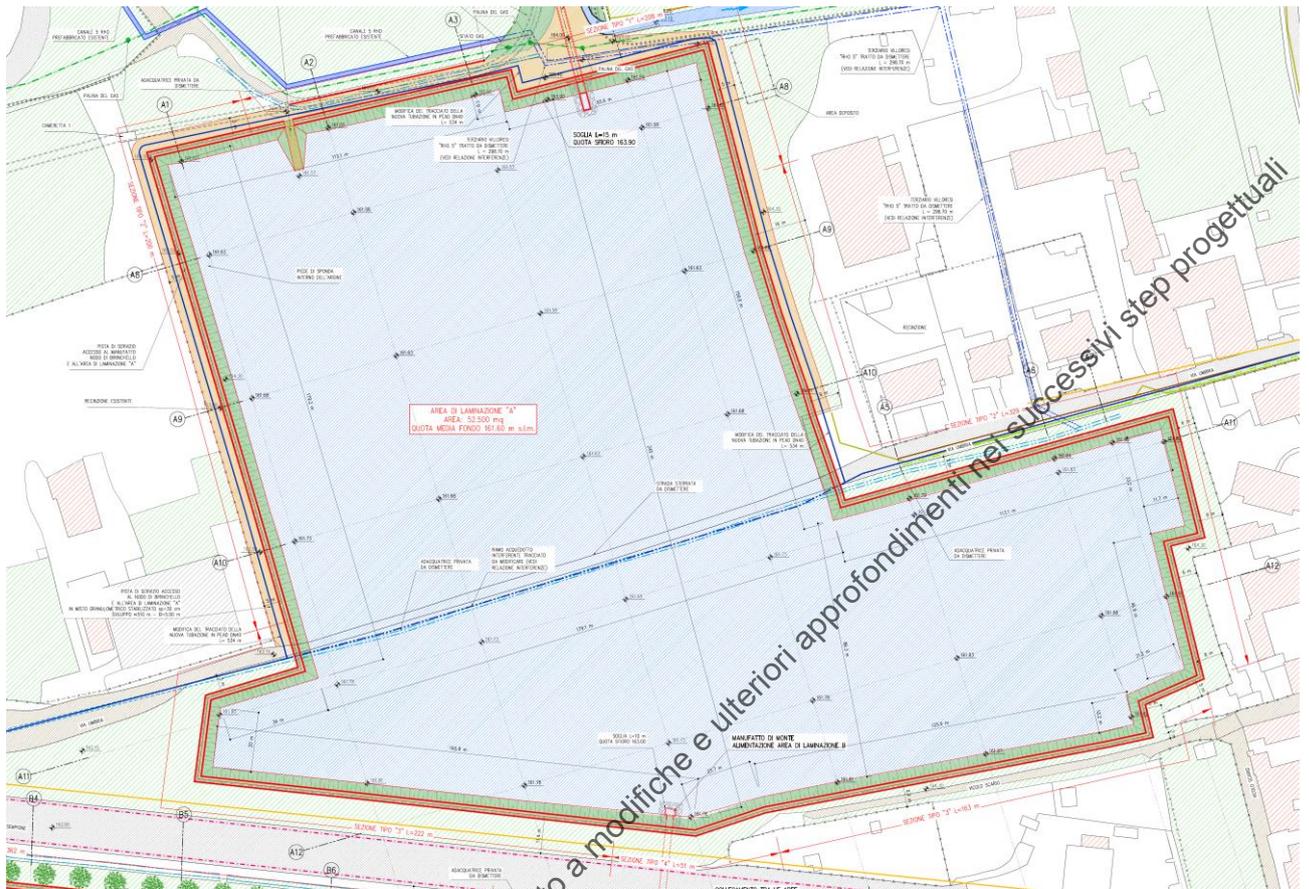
area di laminazione A. Estratto da Tav. 8.1
